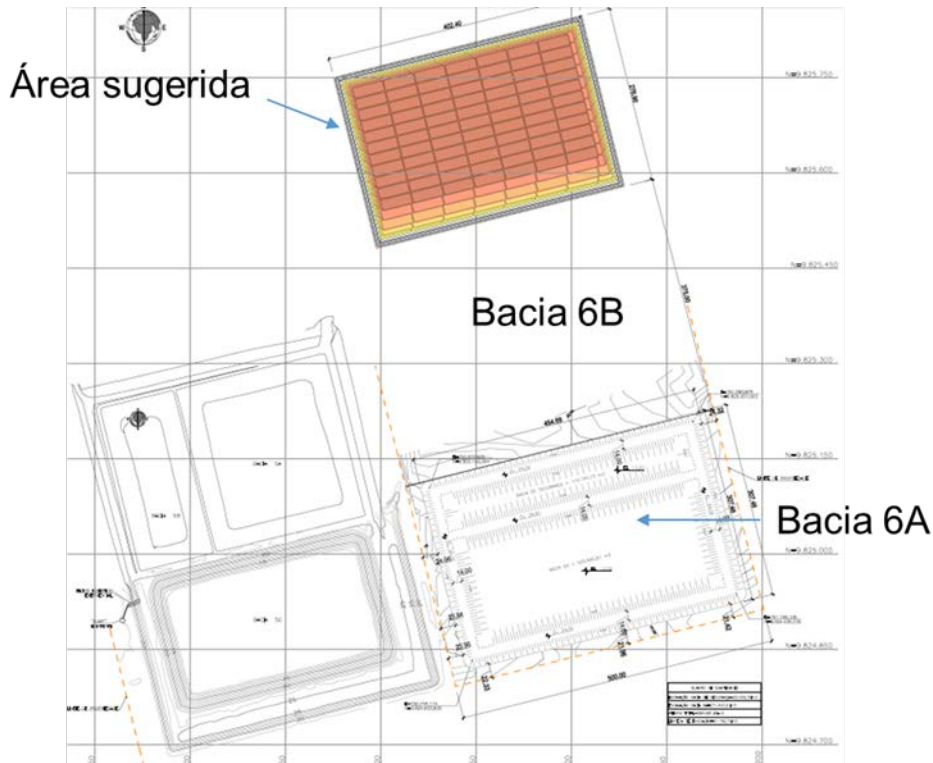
Estudo de encapsulamento para a Imerys Mineração, planta
